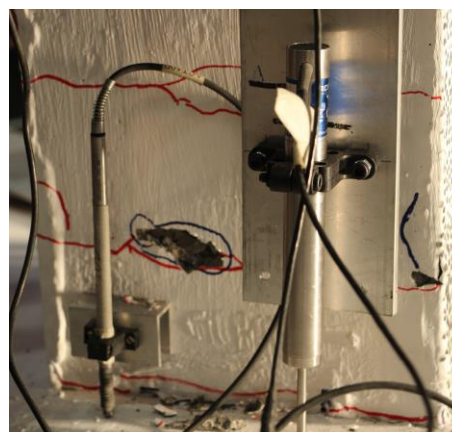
Fissures verticales de compression sur la face latérale gauche de la colonne C2A au LS32
